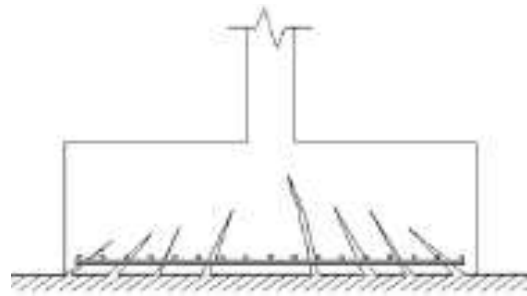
Fallo de una zapata por fisuración excesiva.
